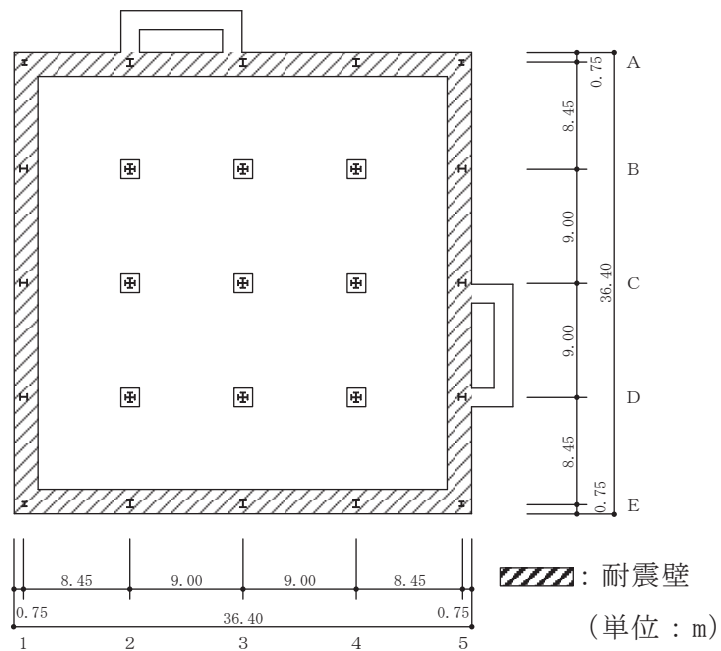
(2) 耐震壁の評価を記載する部材の位置 (B1F, 0. P. 57.3m)
